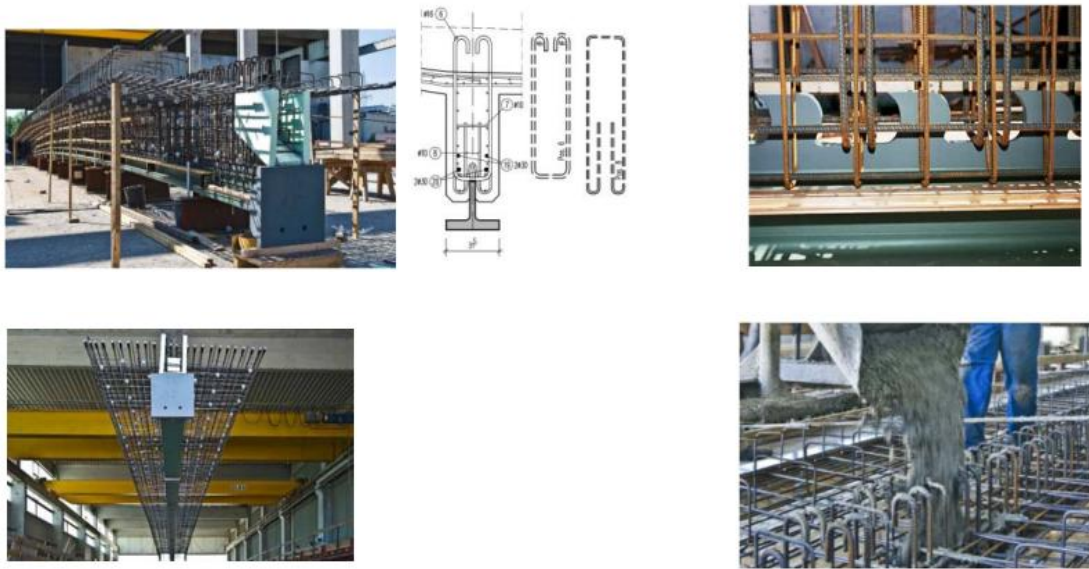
预制场绑扎钢筋和浇筑预制混凝土
